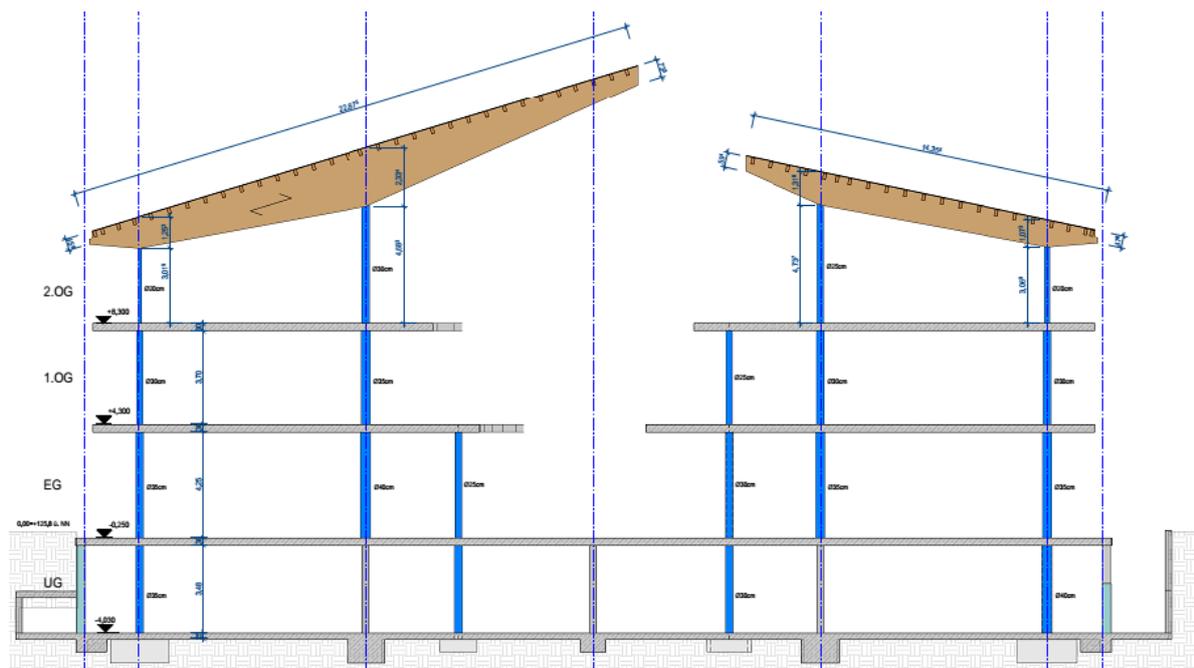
Tragwerk mit aussteifendem Kellerkasten – Schnitt
